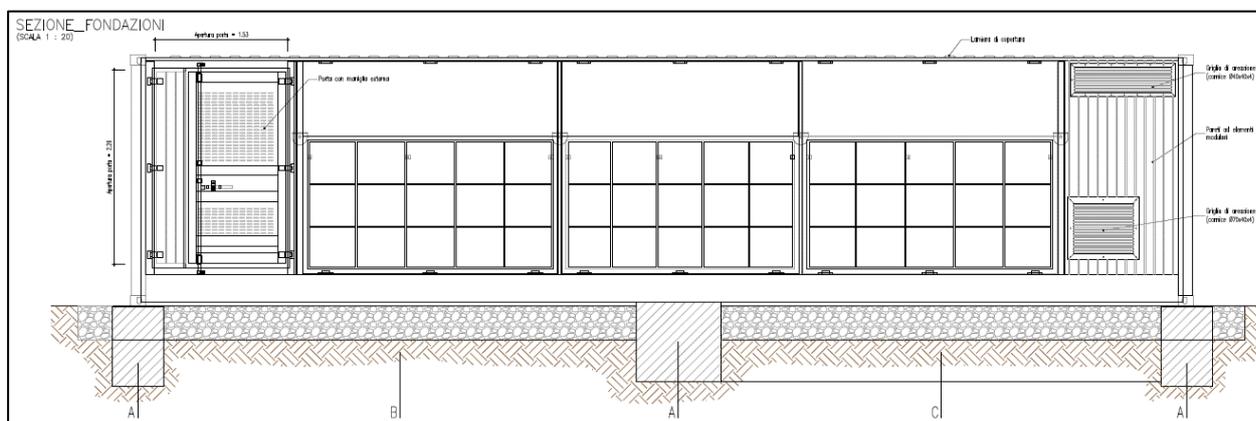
Sezione fondazioni di una cabina di campo e trasformazione
